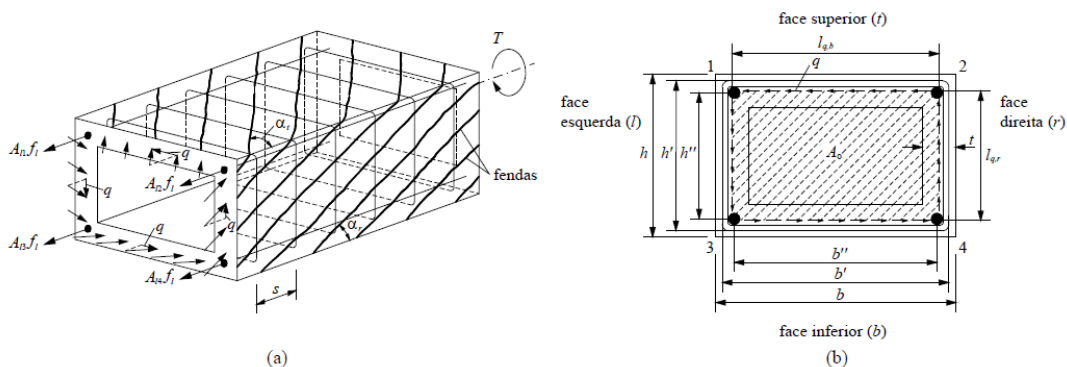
Viga com secção rectangular vazada sujeita à torção pura [27]
